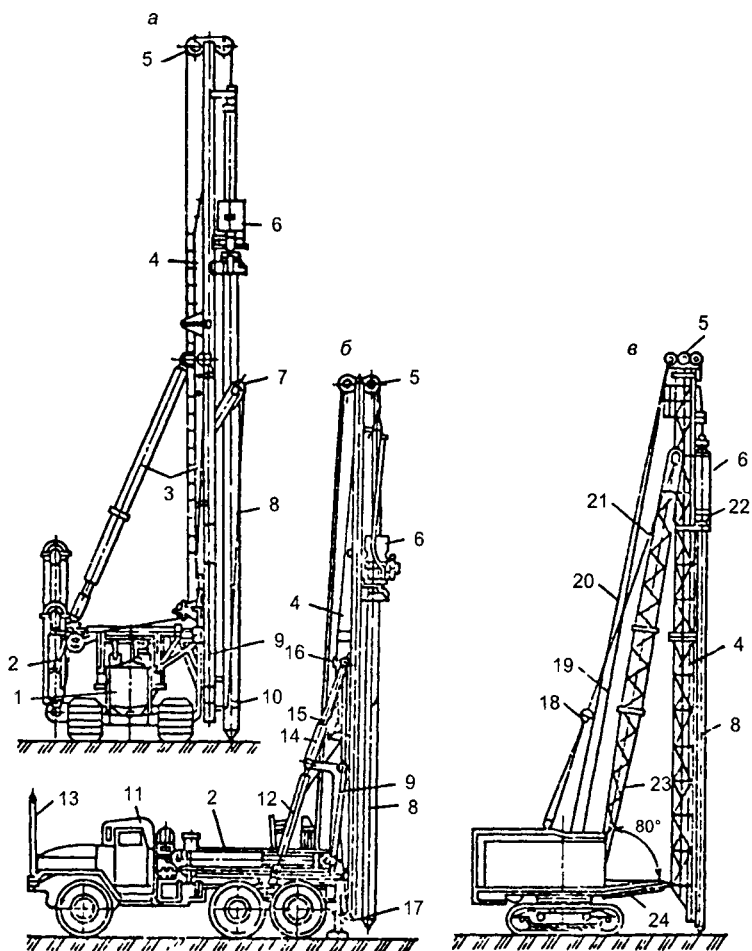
Забивка свай самоходными сваебойными агрегатами:
